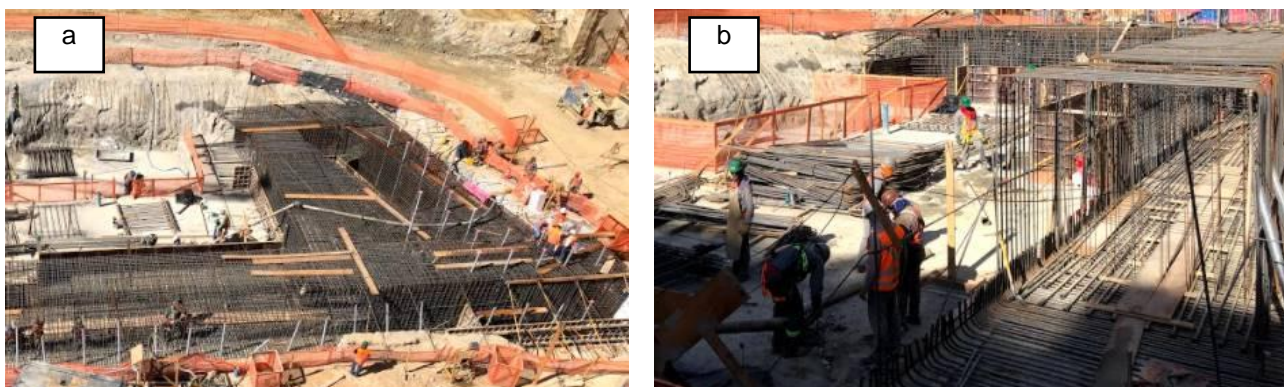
Detalhes da execução da sapata de grandes dimensões da obra Faria Lima Plaza, em São Paulo, SP (Deseq, 2019): (a) vista superior da estrutura; (b) montagem da armação da estrutura.
